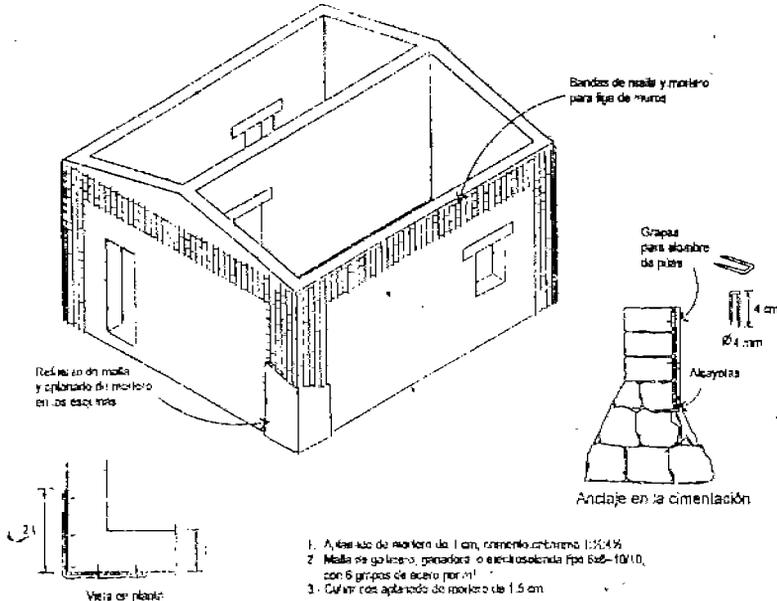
REFUERZO CON BANDAS DE MALLAS Y MORTERO.
